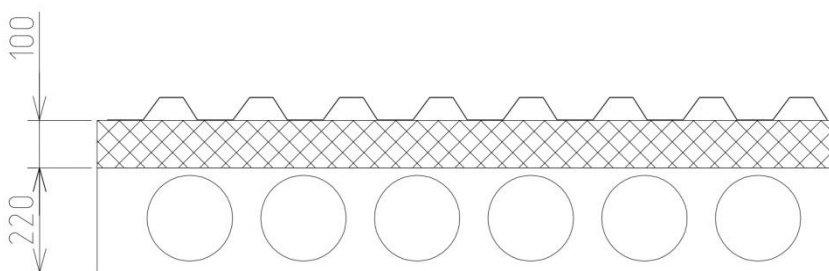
Эскиз перекрытия утепленной крыши.
